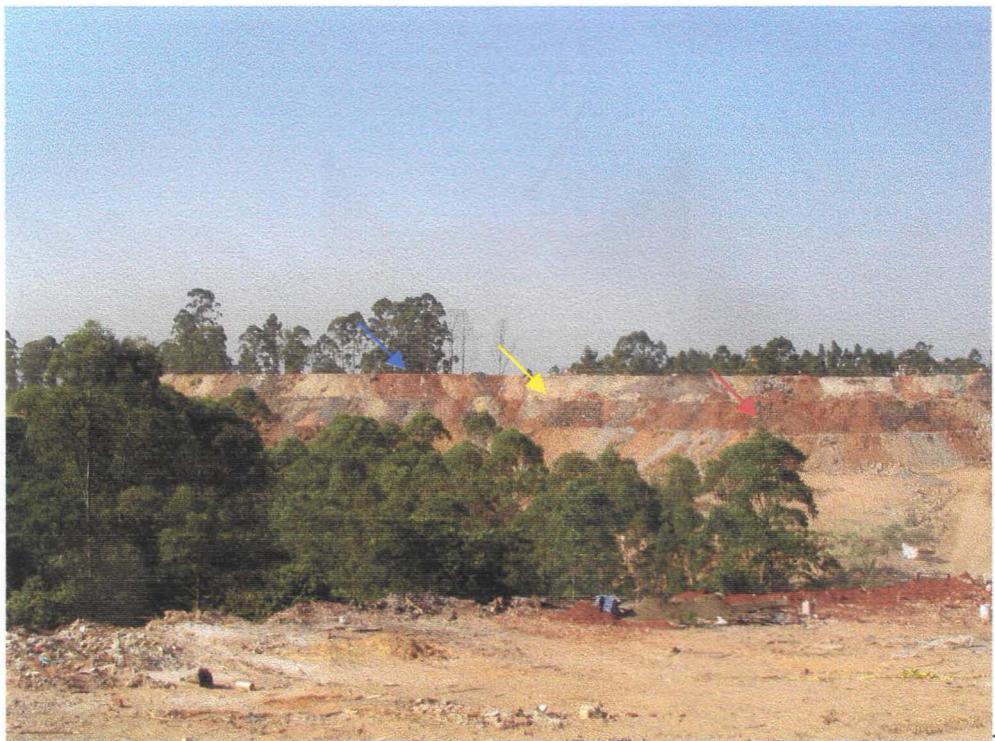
Vista da porção NW do aterro. Em primeiro plano, área de reserva legal onde escoa a água do dreno profundo. Em segundo plano, as setas indicam os três patamares já construídos de cinco previstos, com seis metros de altura cada.
